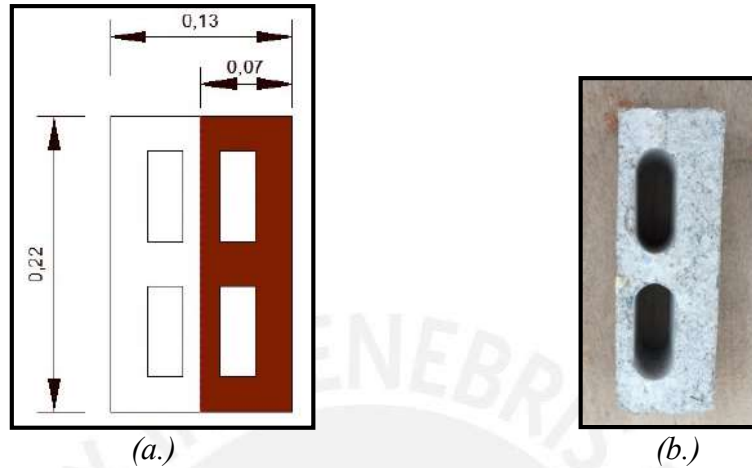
Ladrillo de concreto (a.) Plano con dimensiones de corte (b.) vista de la unidad luego de ser cortado
